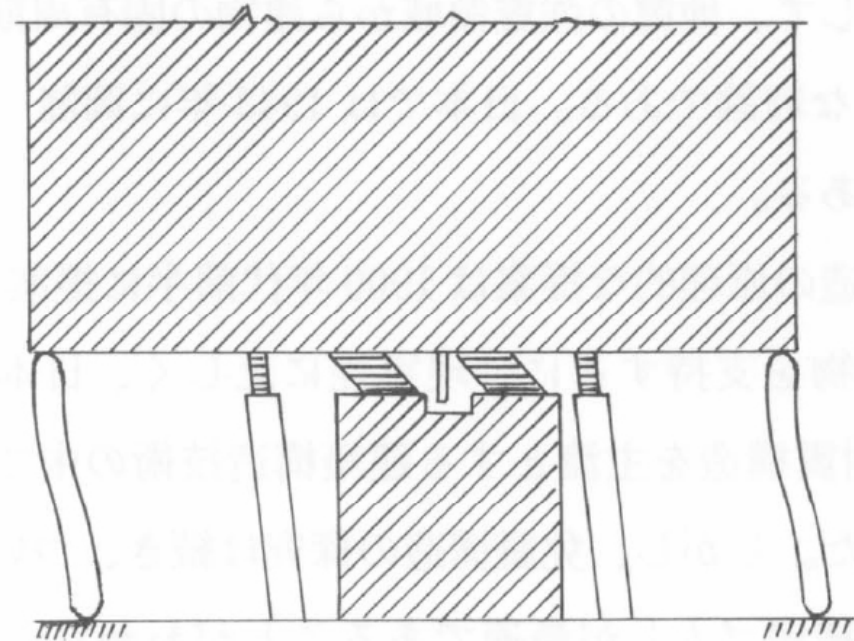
Brevetto del professor Romeo Raul Martel, 1929, archivio [www.strutturista.com](http://www.strutturista.com)
